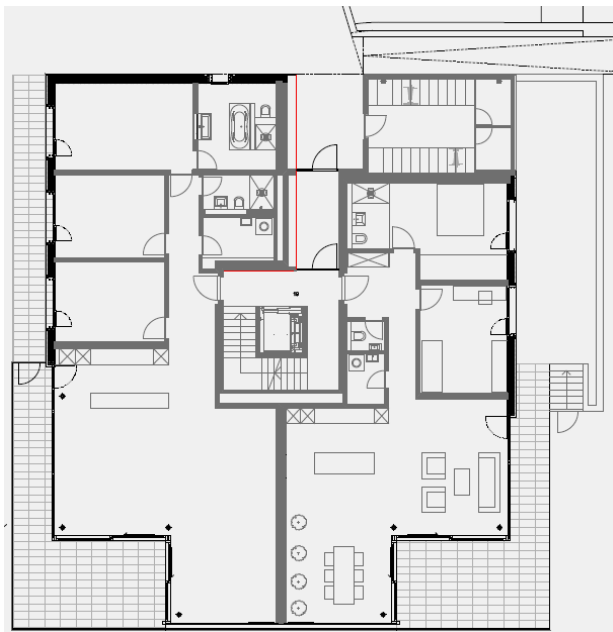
Grundriss Eingangsgeschoss
